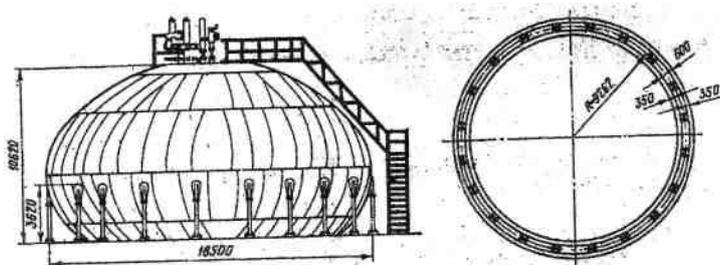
Каплевидный резервуар с экваториальной опорой
